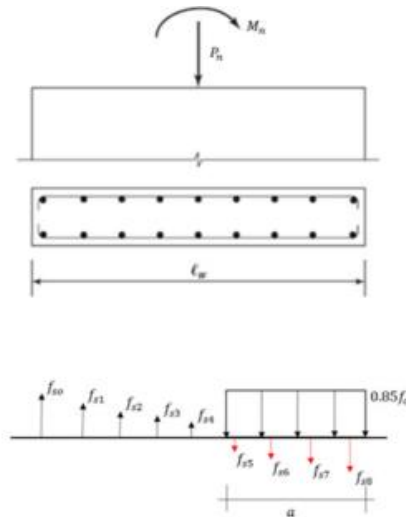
Representación de las fuerzas actuantes en las barras de refuerzo de los sistemas de muro estructural
